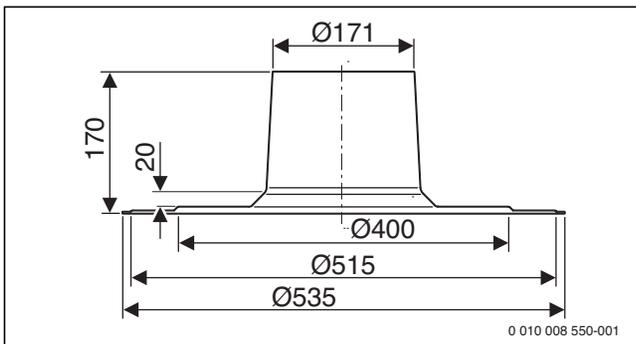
Flachdach-Klebeflansch für DN 110/160 (Maße in mm)
